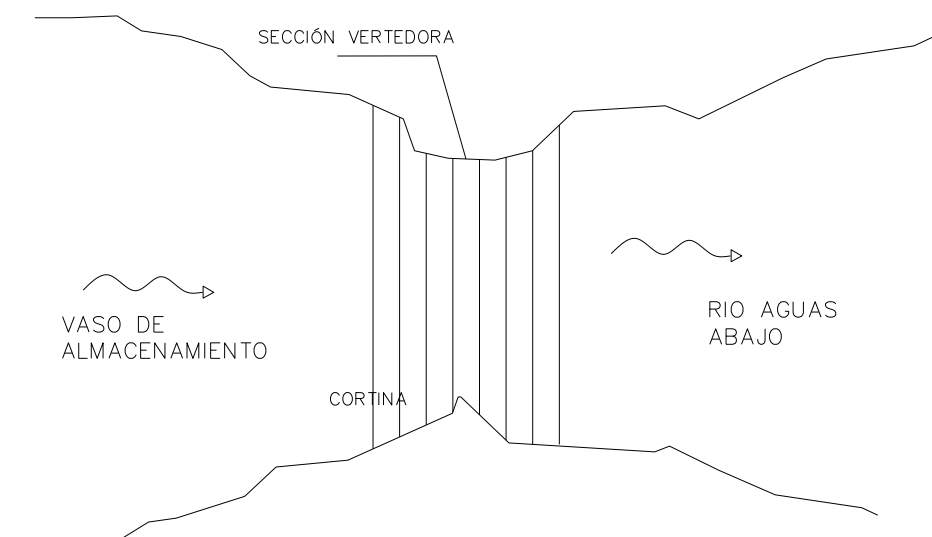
OEVA tipo Rebosadero a base de Gaviones. Sección cresta ancha.
